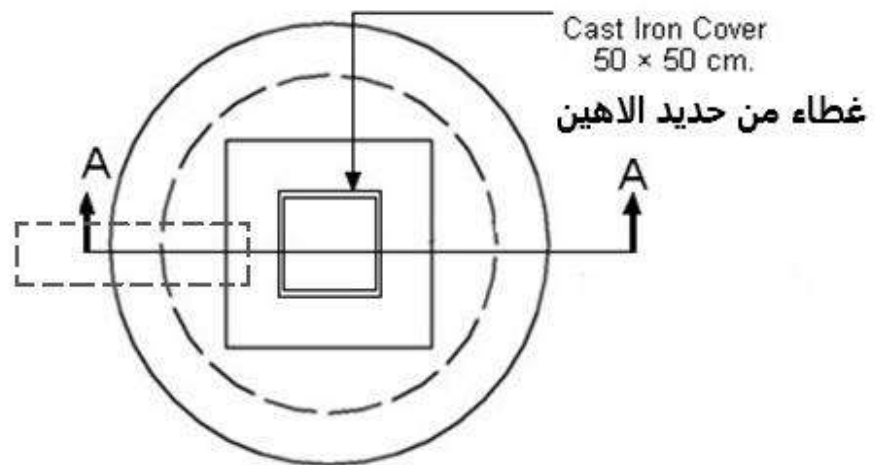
مسقط افقي للسبتتك (حوض التعفين)
